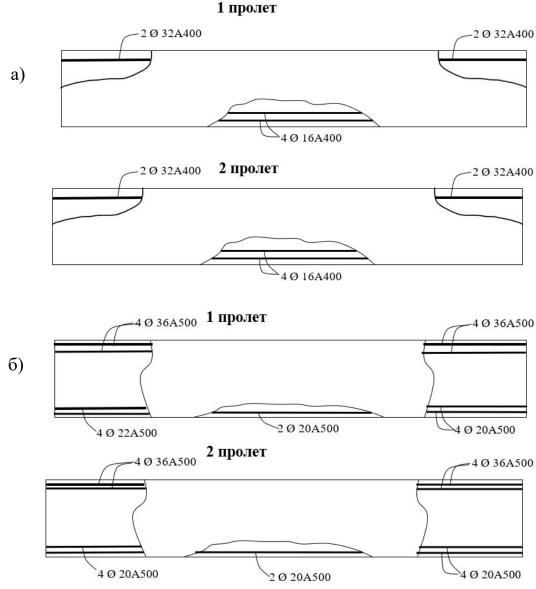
Армирование двух пролетов ригеля второго яруса а) для монолитной рамы 9-ти этажного здания; б) для монолитной рамы 25-ти этажного здания;
